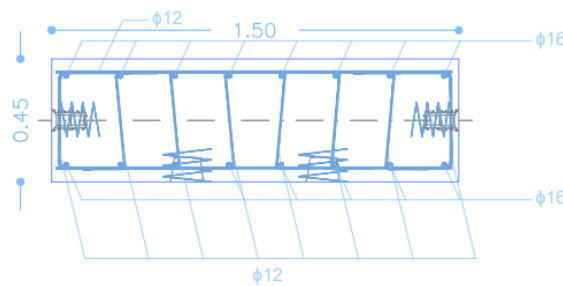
Plano Dovela – Armadura Sección Transversal – Dirección Longitudinal
